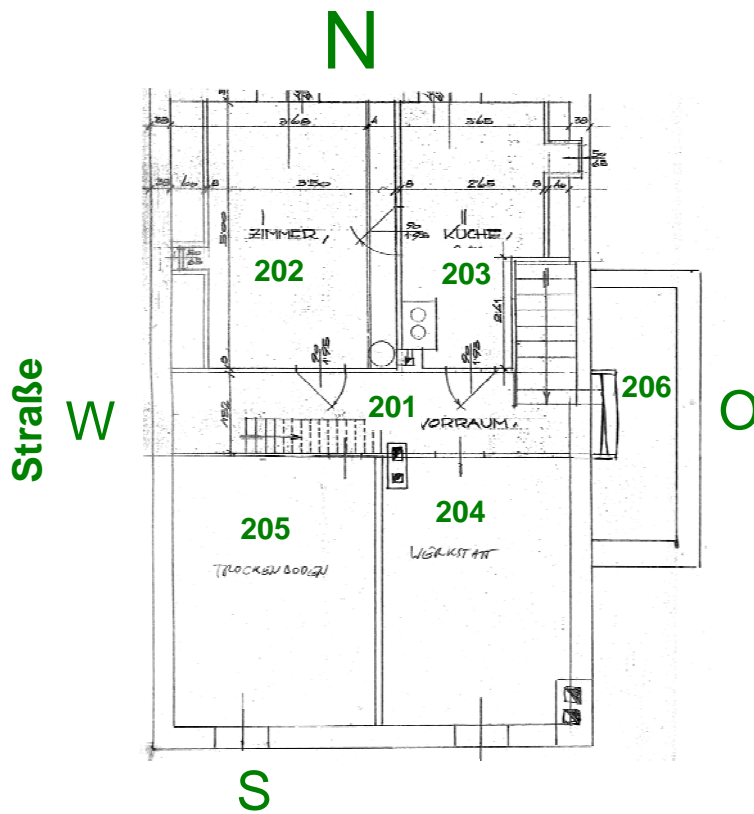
Grundriss mit Raumnummern, Dachgeschoss
